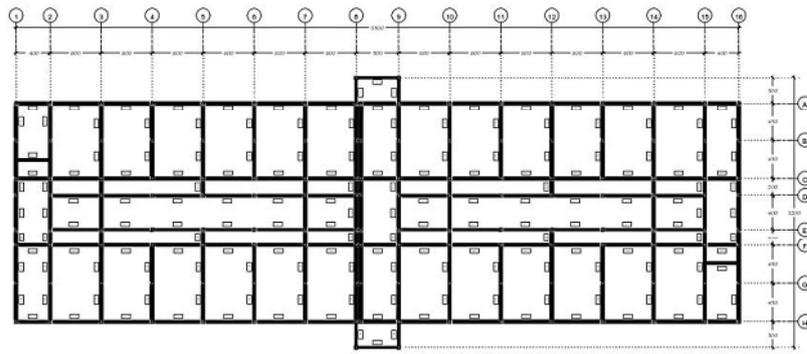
83 Rencana Pondasi Tapak Asrama
